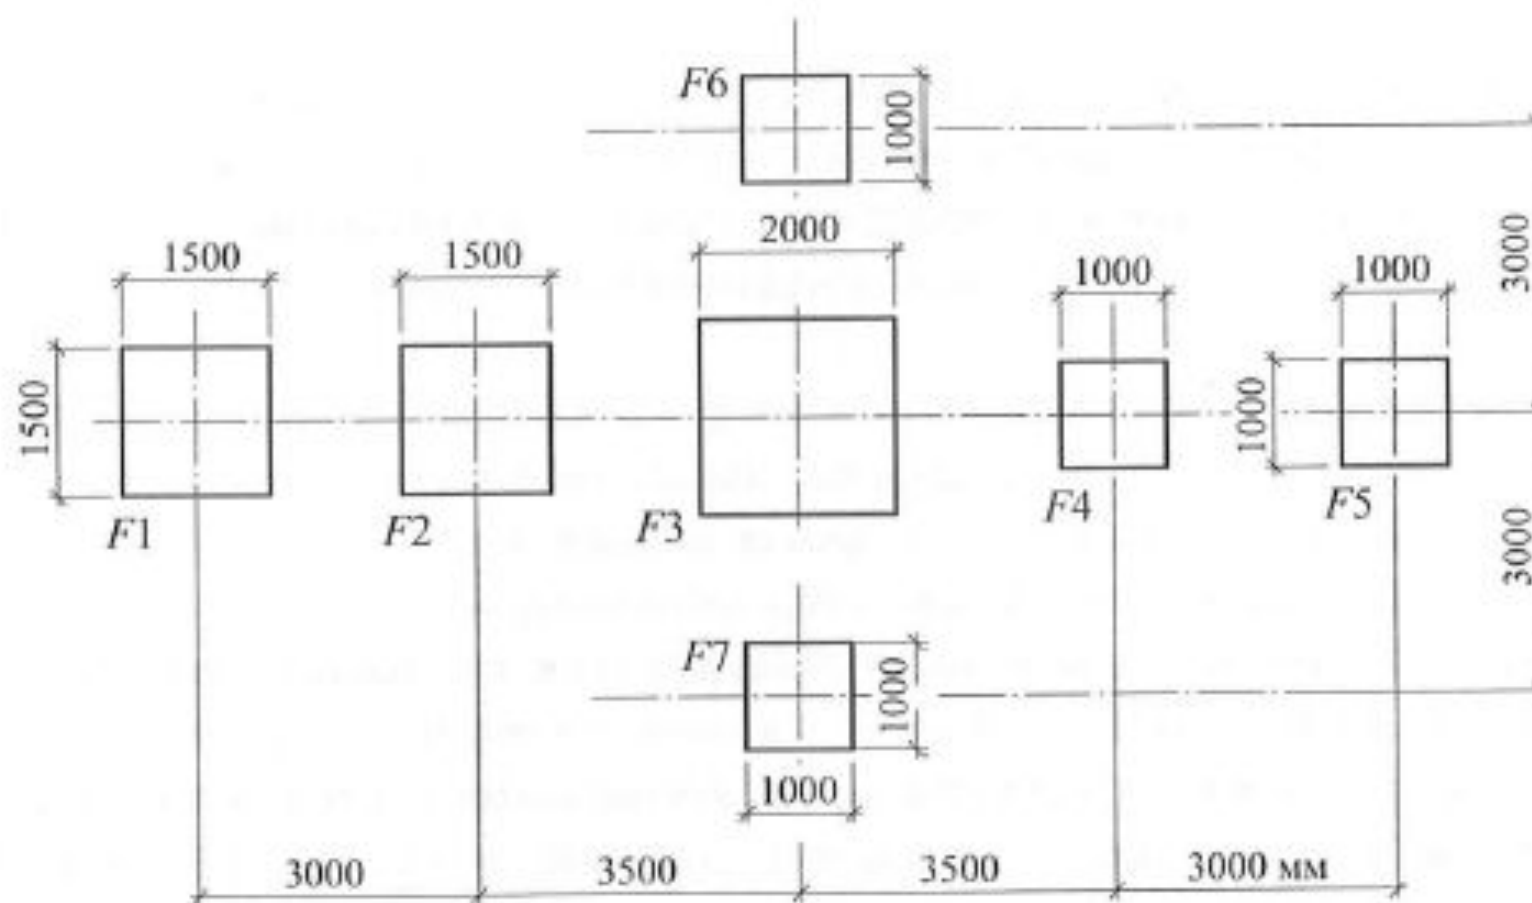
Схема испытаний грунтового основания группой фундаментов на виброползучесть
